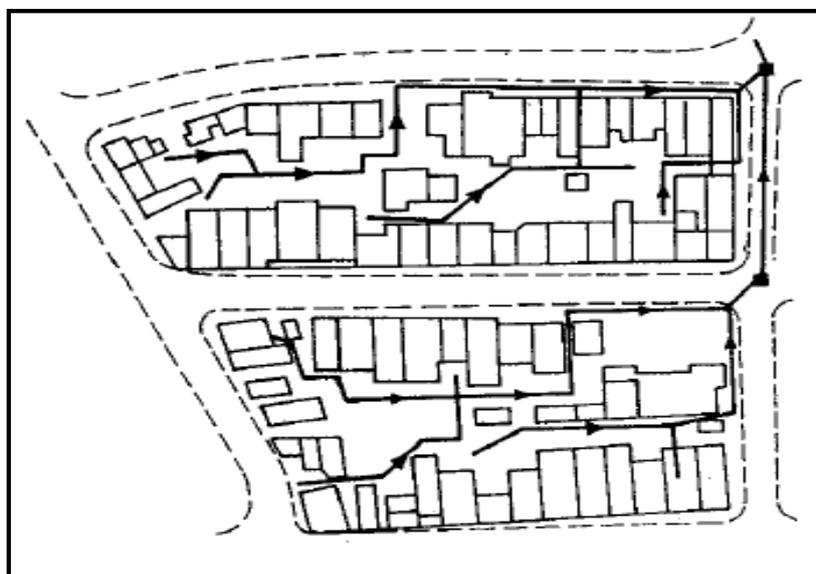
Sistema de alcantarillado simplificado. Fuente:
